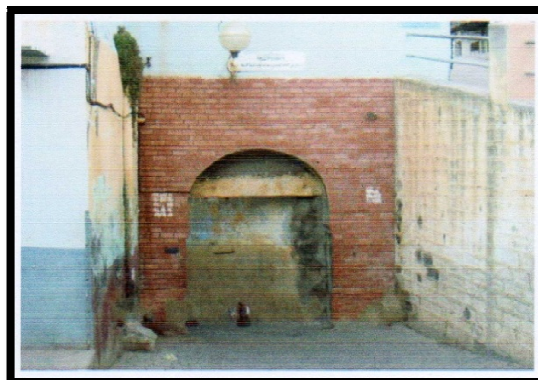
La porte ou Bab El Madina après sa restauration
